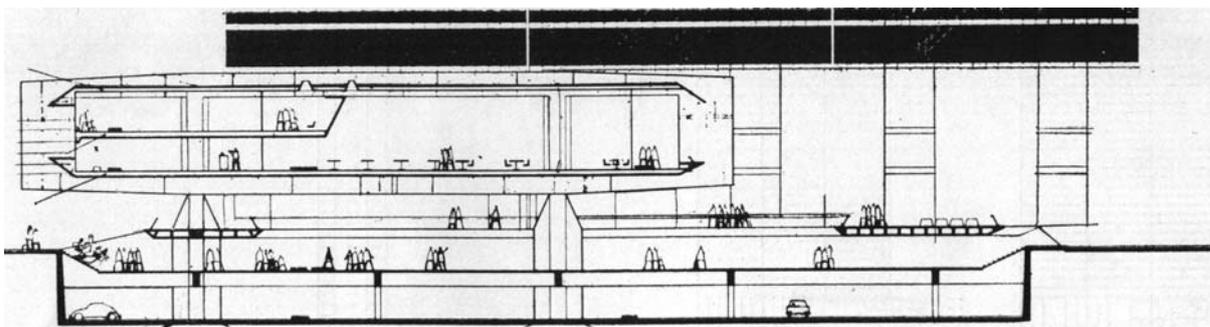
corte transversal B: subsolo: garagens; nível semi-enterrado: áreas comerciais; praça elevada; 1º nível do pavilhão elevado: restaurante e cozinhas; 2º nível do pavilhão: áreas de lazer.
